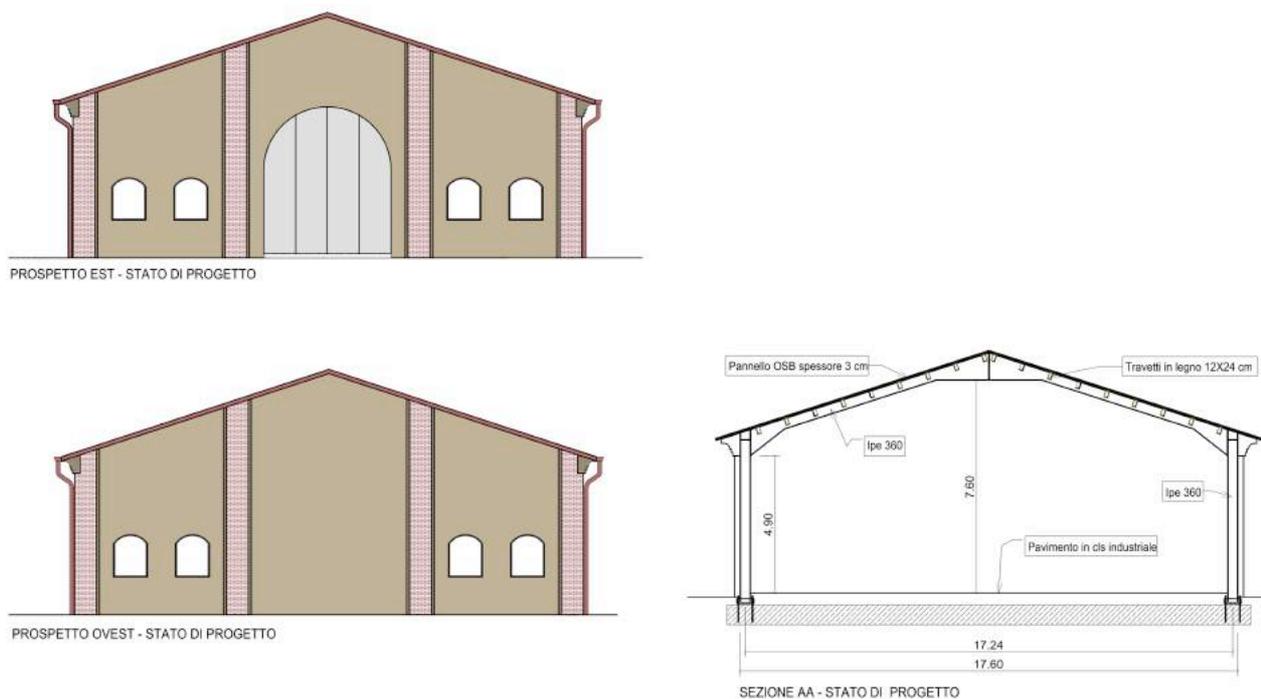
Pianta, prospetti e sezione dell'intervento in progetto
